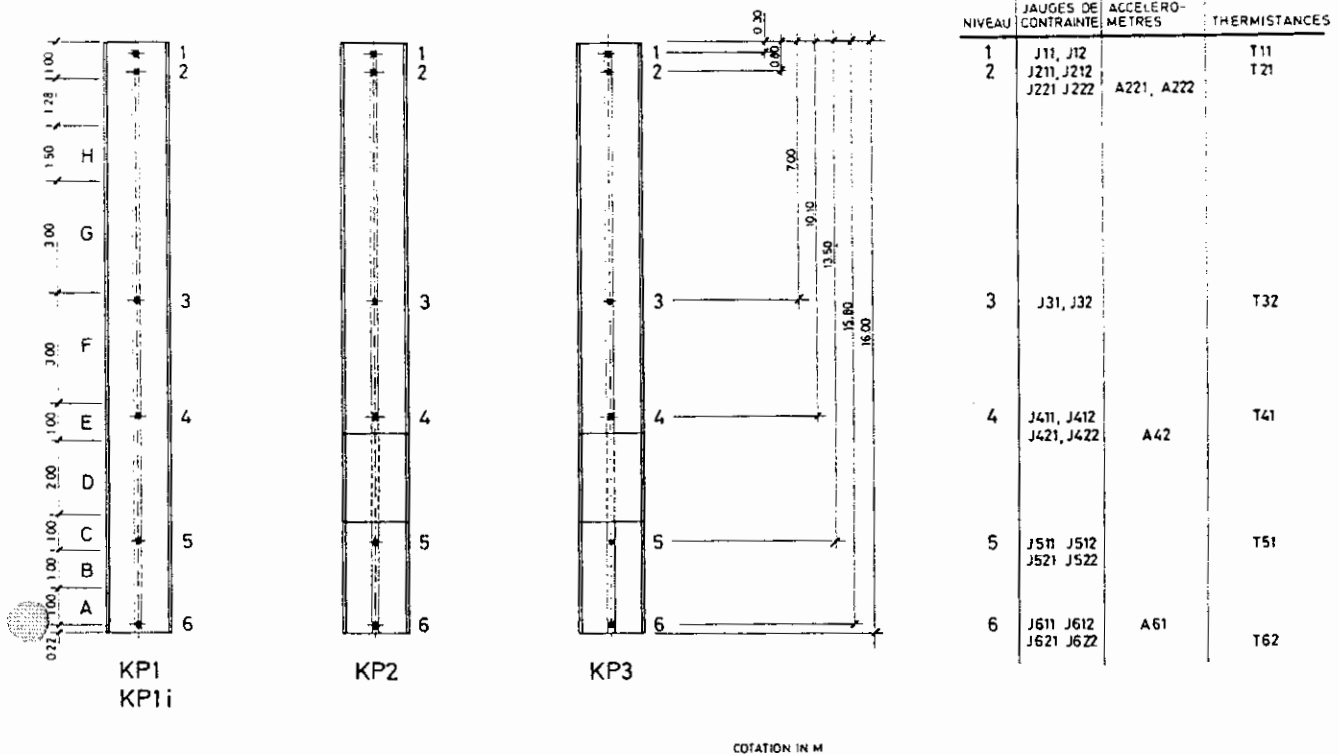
Disposition des instruments de mesures sur les pieux.
